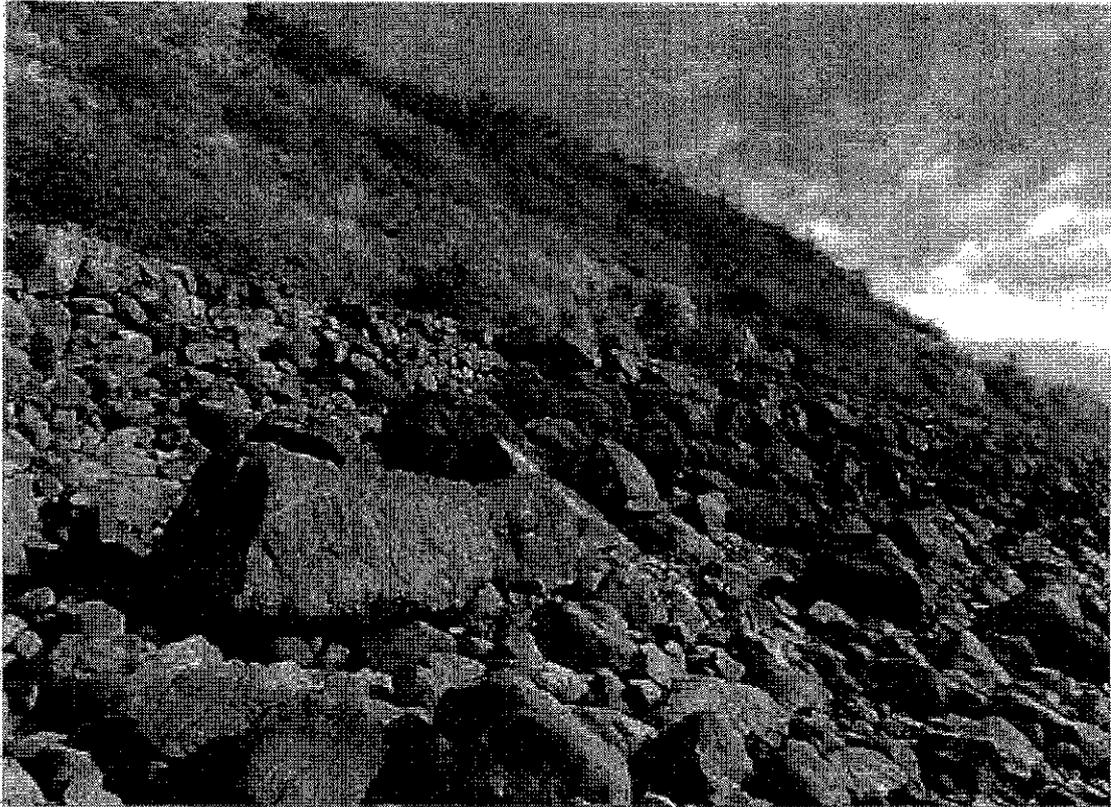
Muro de Escollera en proceso de destrucción que deberá ser reconstruido
